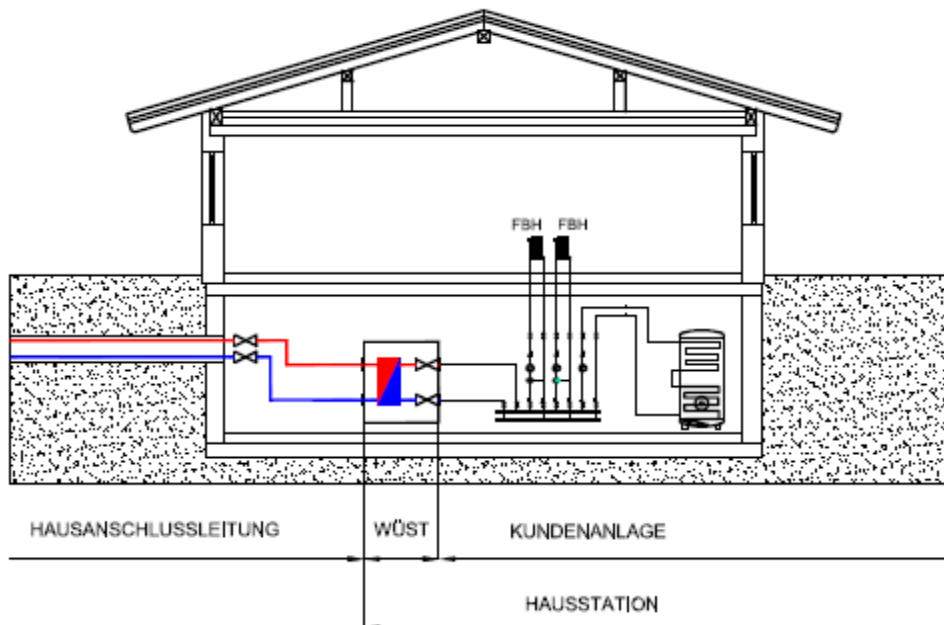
Grenze zwischen Hausanschlussleitung, Wärmeübergabestation (WÜST) und Hausanlage
